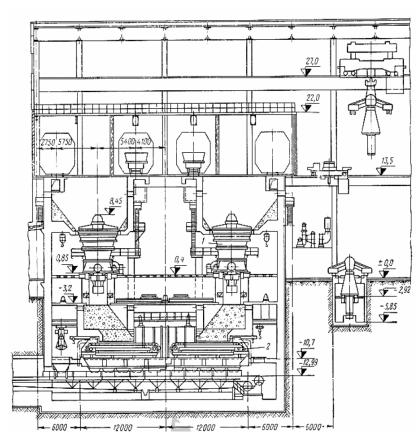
Корпус крупного дробления с установкой дробилок ККД-1500/180: 1 – конусные дробилки; 2 – пластинчатый питатель
